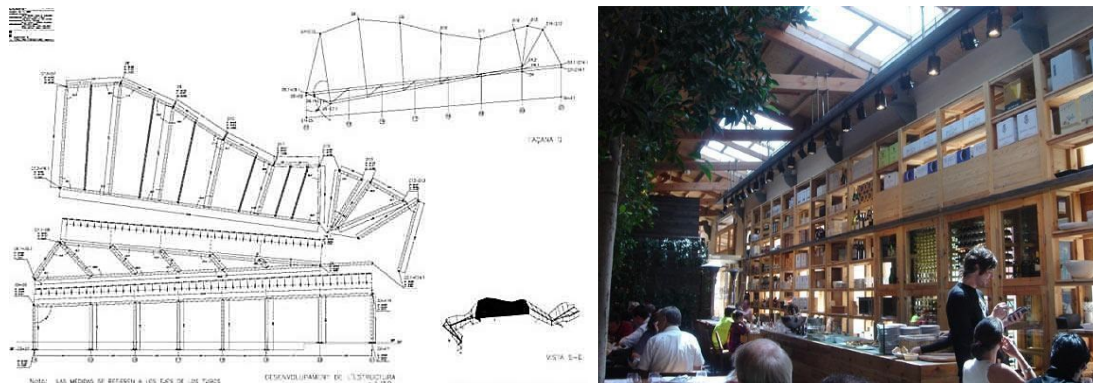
Mercado de Santa Caterina, detalle de la estructura de la cubierta y su aplicación al interior del mismo.
